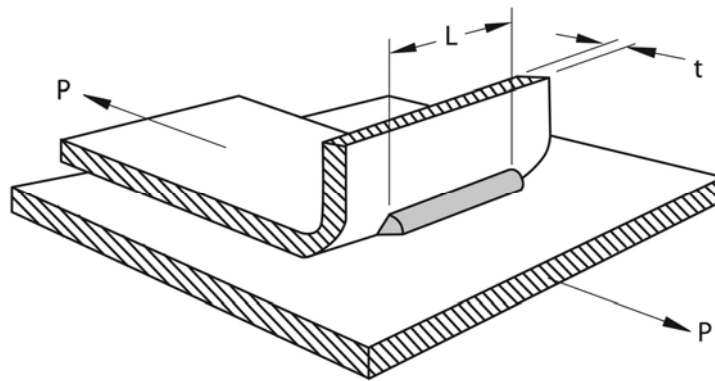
Soldadura abocinada en media V
